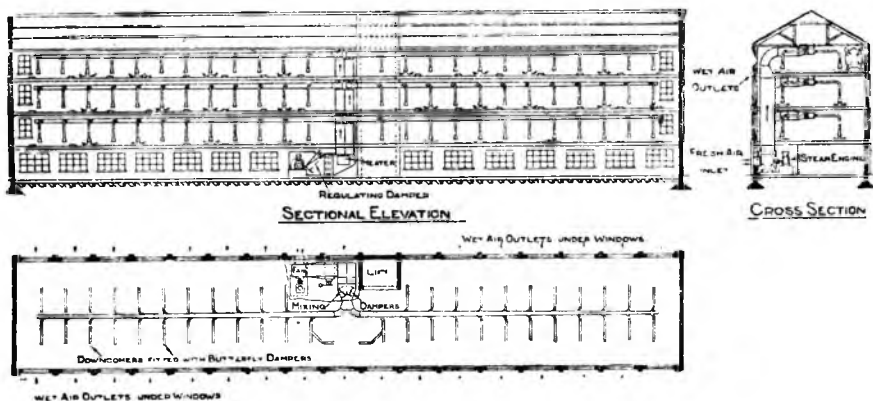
Sectional elevation—Поперечный разрез. Plan—План. Fresh air inlets—Впуск свежего воздуха. Fan—Вентилятор. Motor—Мотор. Boiler—Паровой котел. Hot air flue—Приток горячего воздуха. Heaters—Калориферы. Mixing Damper—Смесительная коробка. Downpipes with dampers for each—Выбрасывающие трубы.
